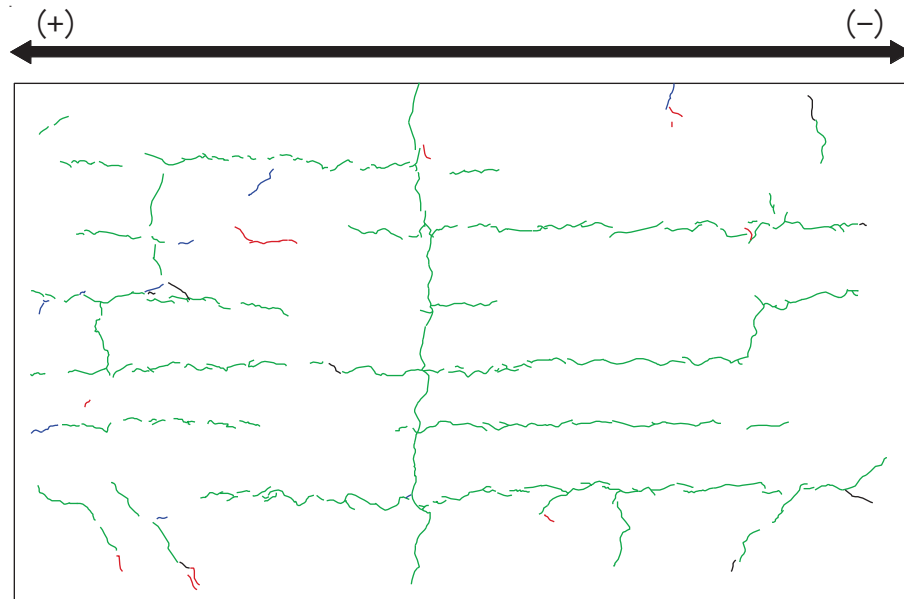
(3) 乾燥試験体 [1] 1/5000rad. におけるひび割れ図
